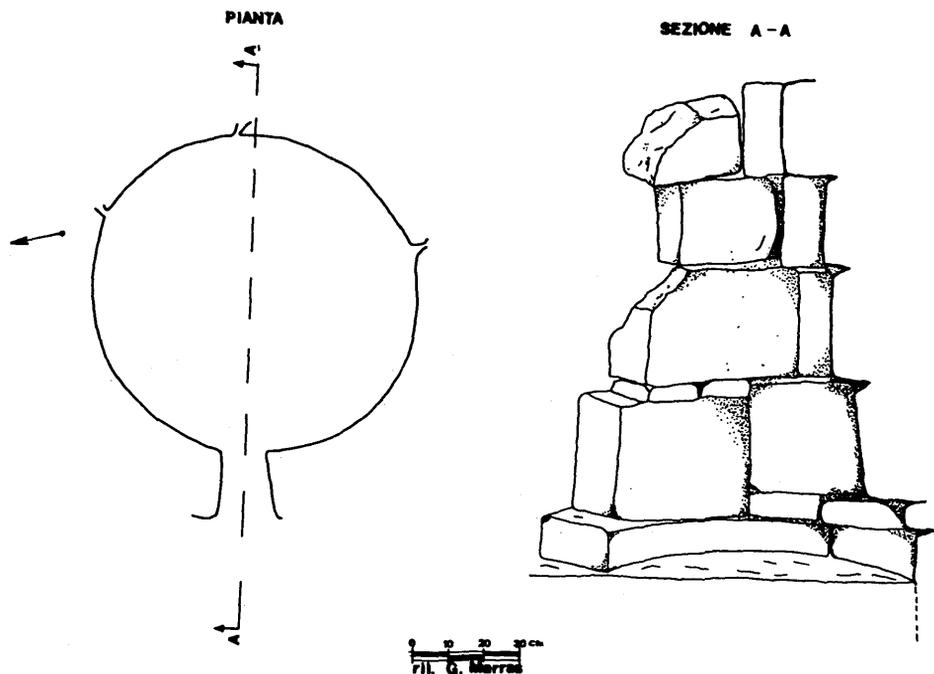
Pozzo o fonte di Arvaras (Anela), planimetria e sezione.
